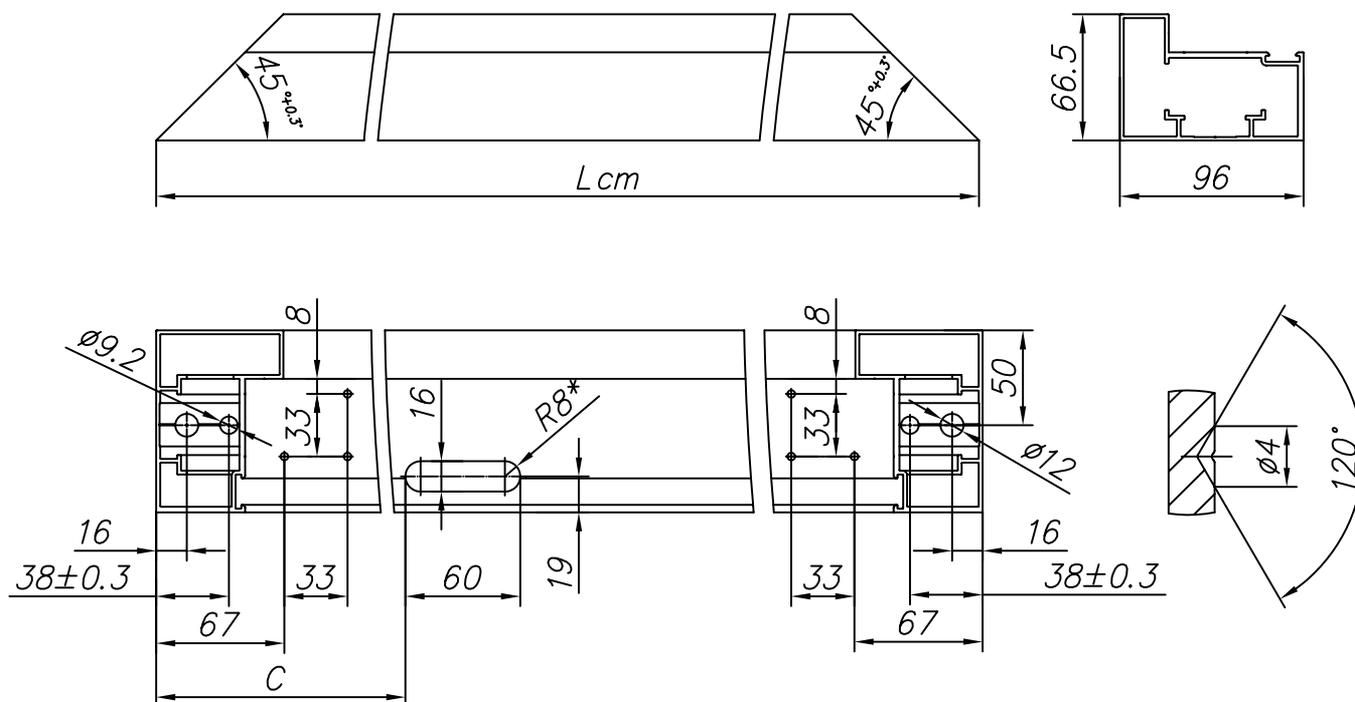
Изготовление стойки (профиль рамы FLGU.400.0102)
